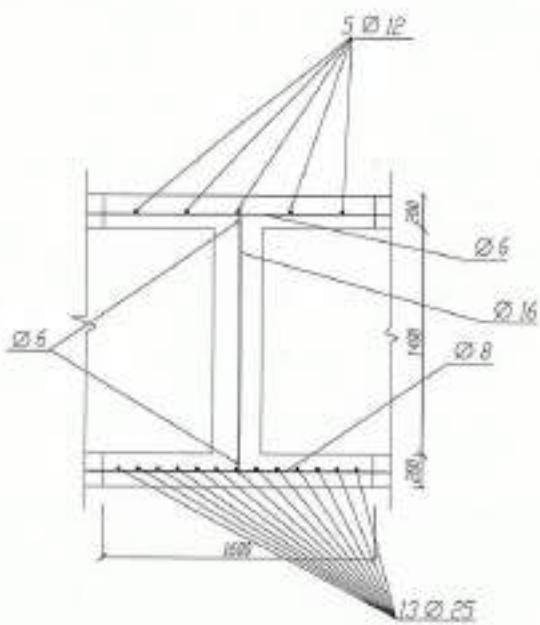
Схема армирования фундамента на участке между осями Г – Ж
